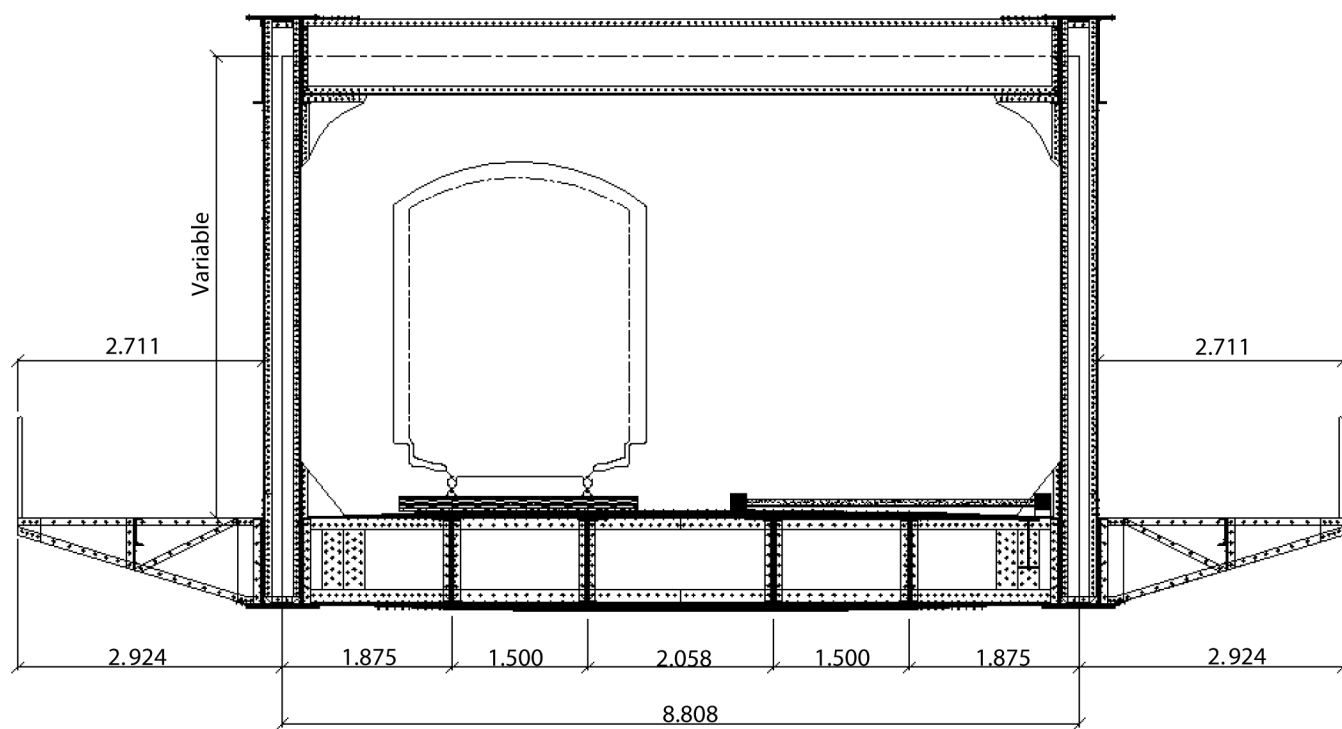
c : Coupe transversale du pont-rails de Zifta.
